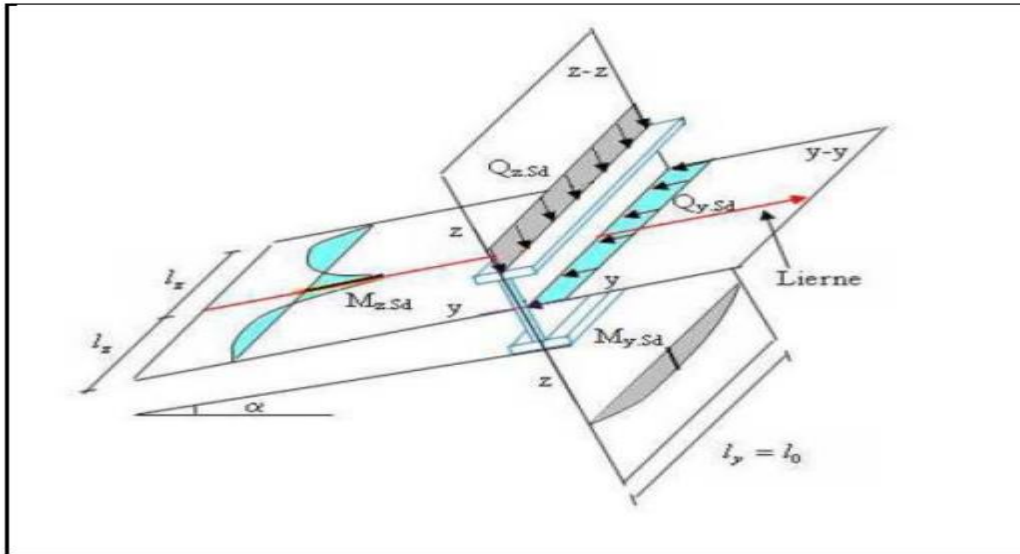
Panne de toiture en flexion sous les différents plans de chargement
